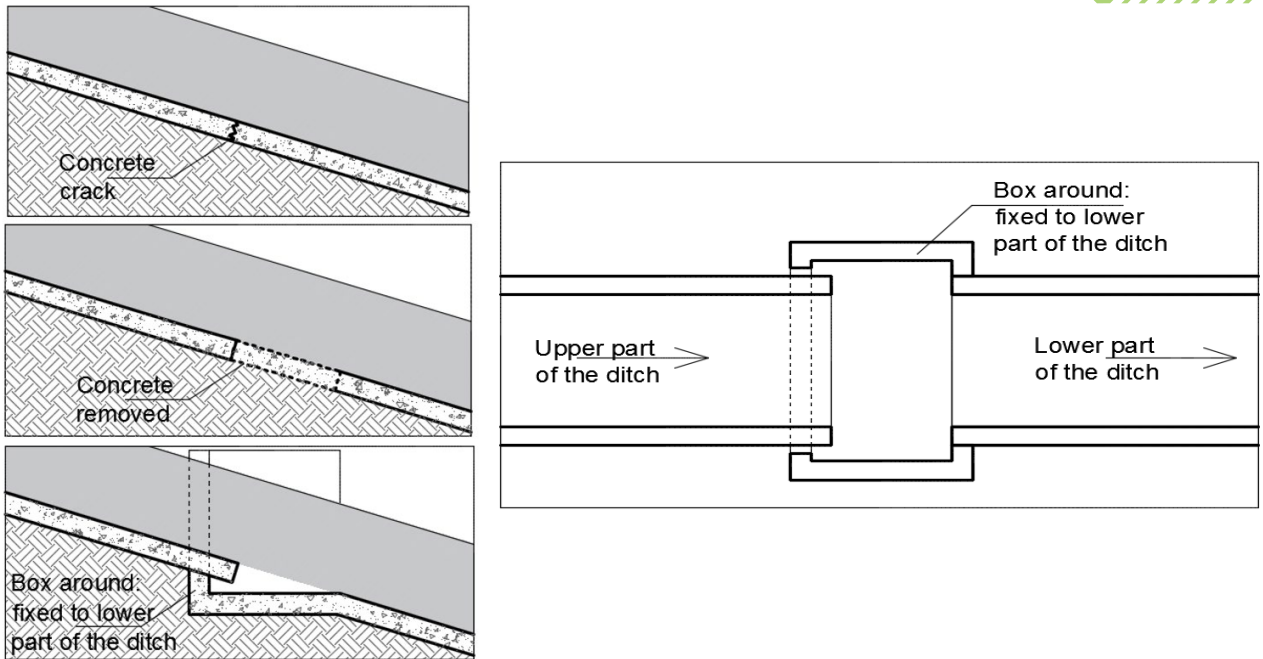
Corrección de cunetas con separación longitudinal (vista perfil a la izquierda y planta a la derecha)
